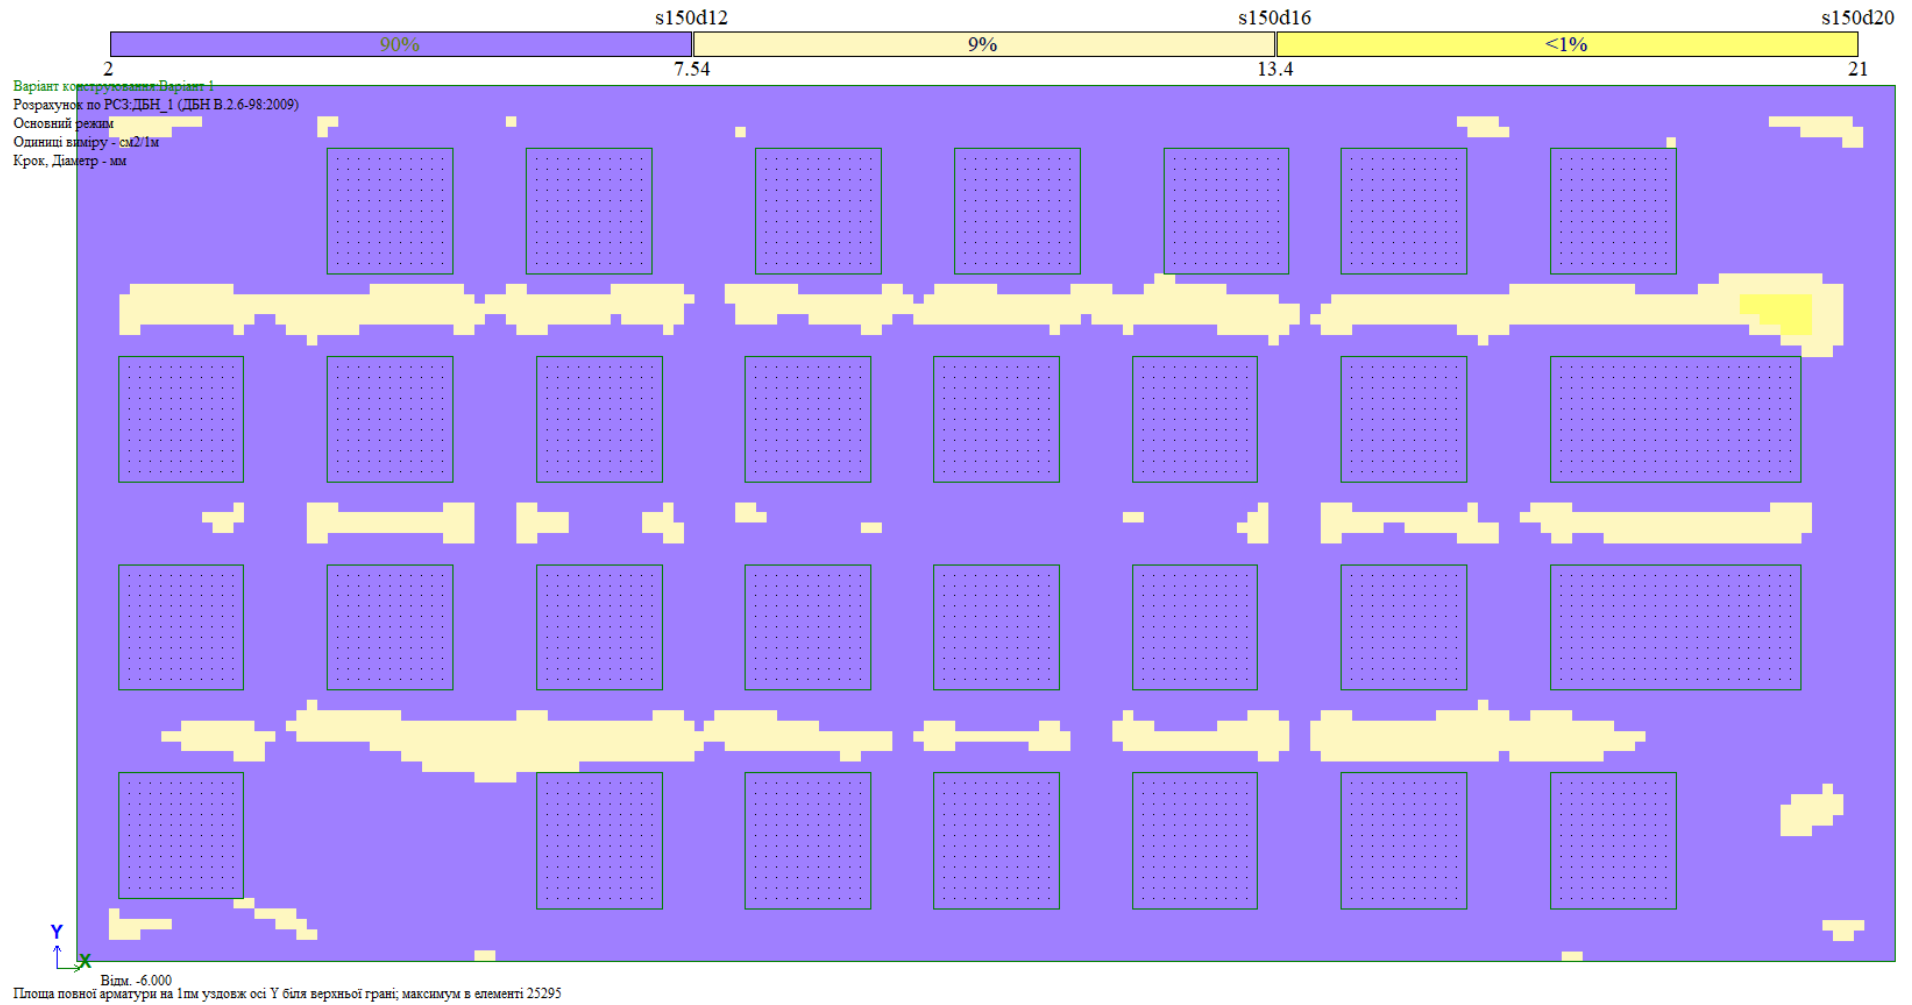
Армуння верхньої зони вздовж осі Y (см²/1м) фундаментної плити
